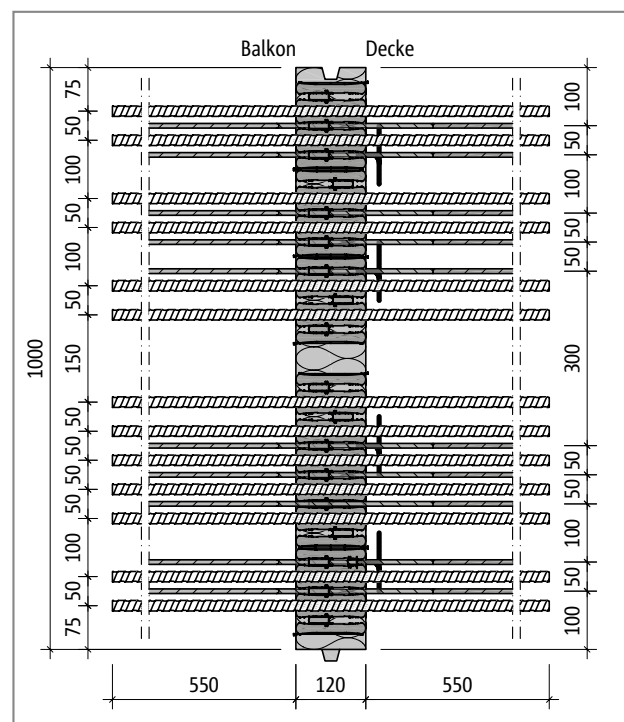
Schöck Isokorb® Typ KXT95-Combar-V10: Produktgrundriss
